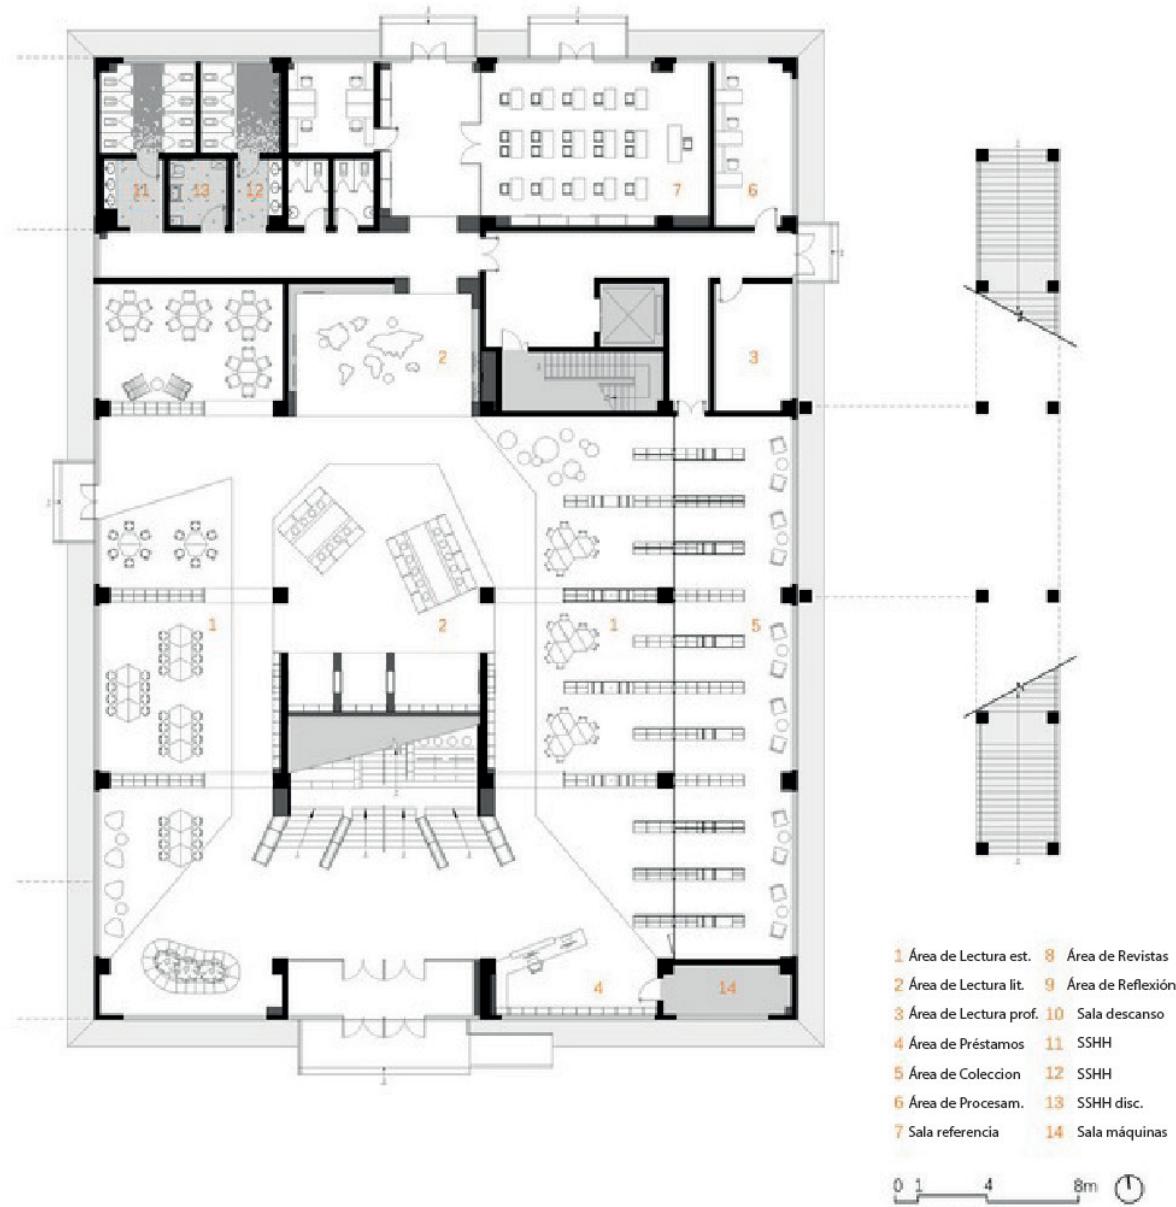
Planta Baja, Biblioteca Escuela Hebi. Fuente: ArchDaily (2023)
